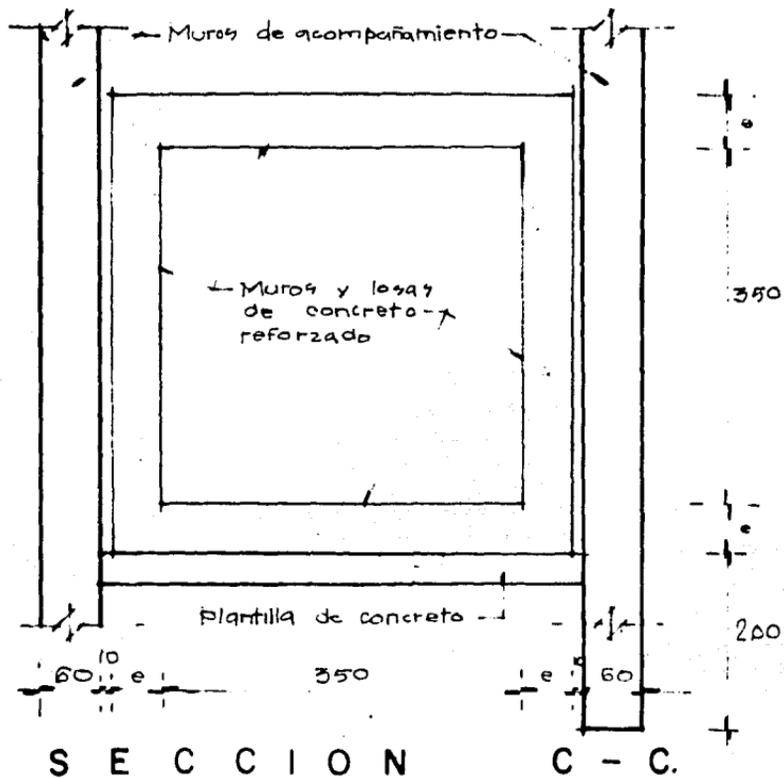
Sección transversal de un conducto cuadrado. Excavación - cielo abierto.
